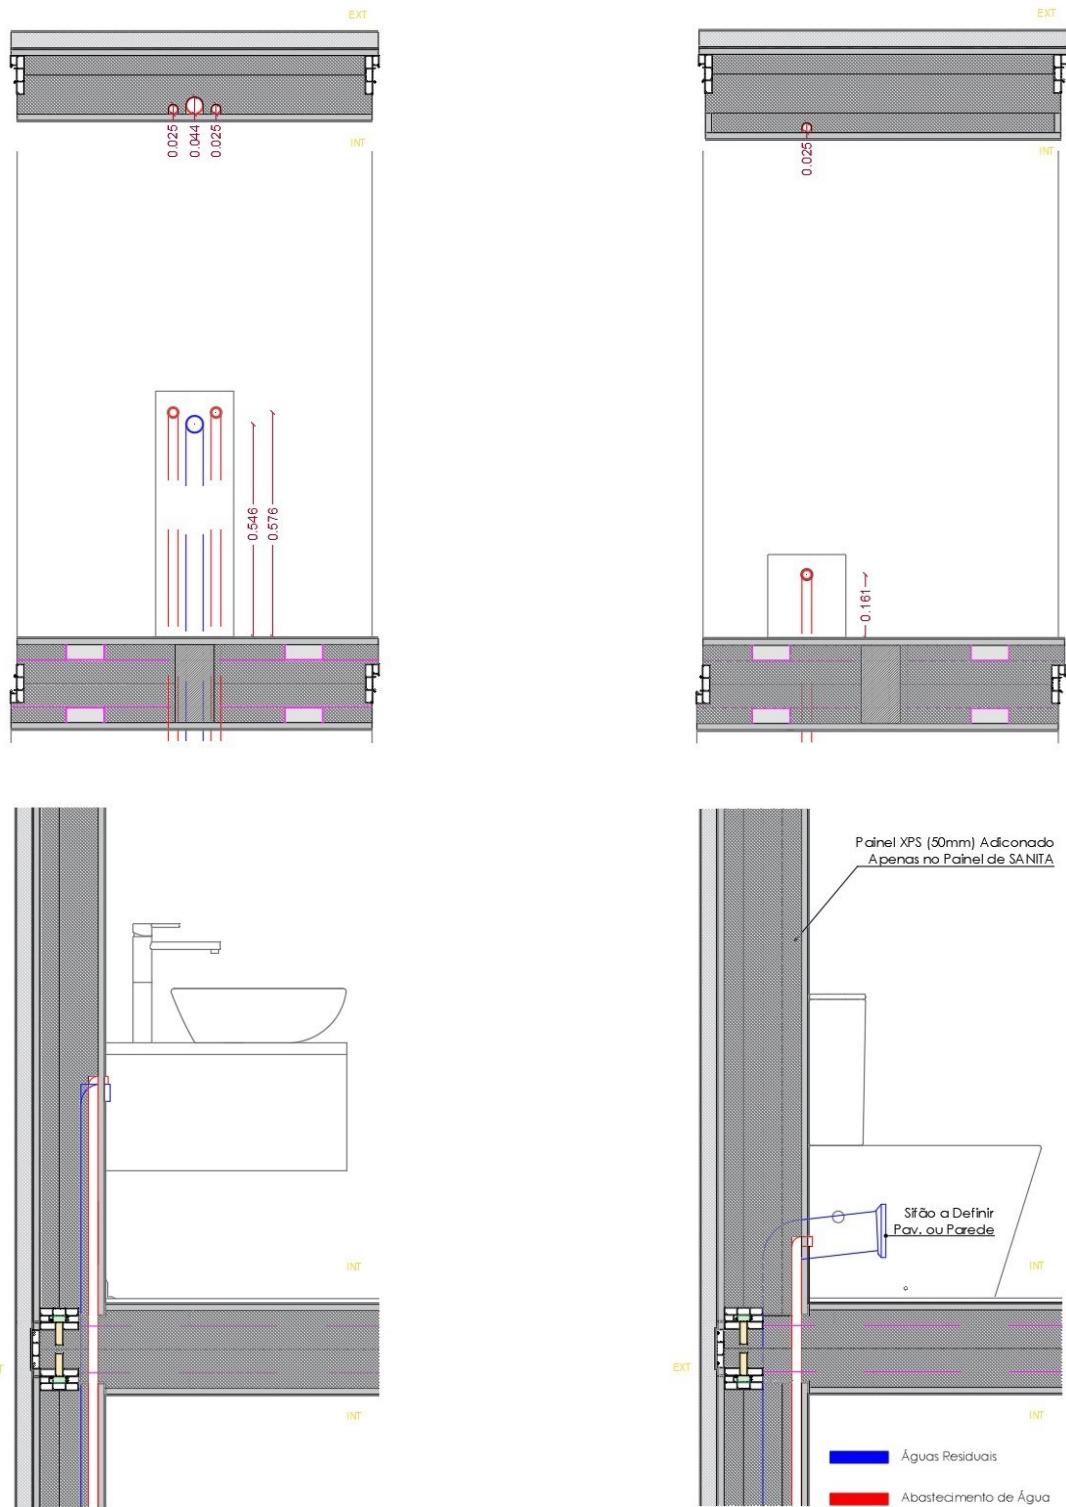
/30. Solução Final – Pormenor construtivo de parede/piso ligação hidráulica (lavatório e sanita respetivamente).
